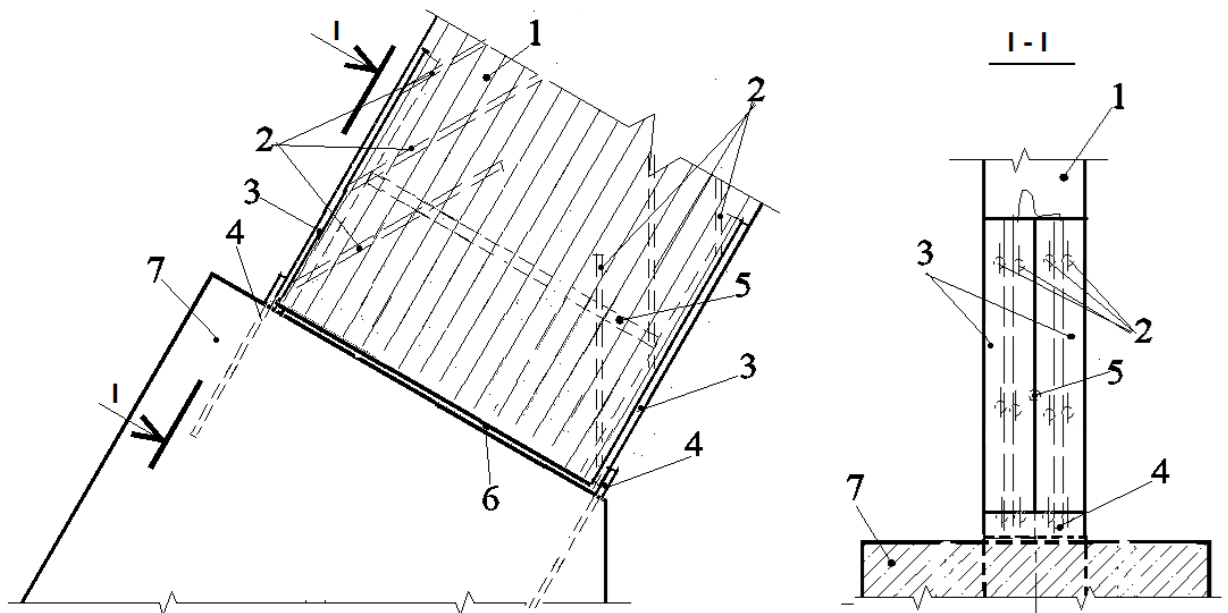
Схема шарнирного узла опирания арки на железобетонную опору
